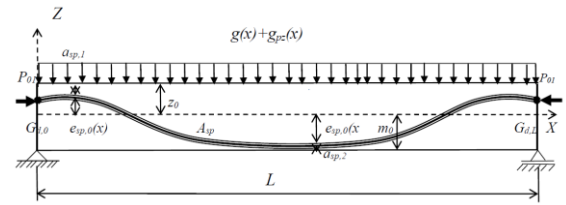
Схема для расчета постнапряженного элемента перекрытия
